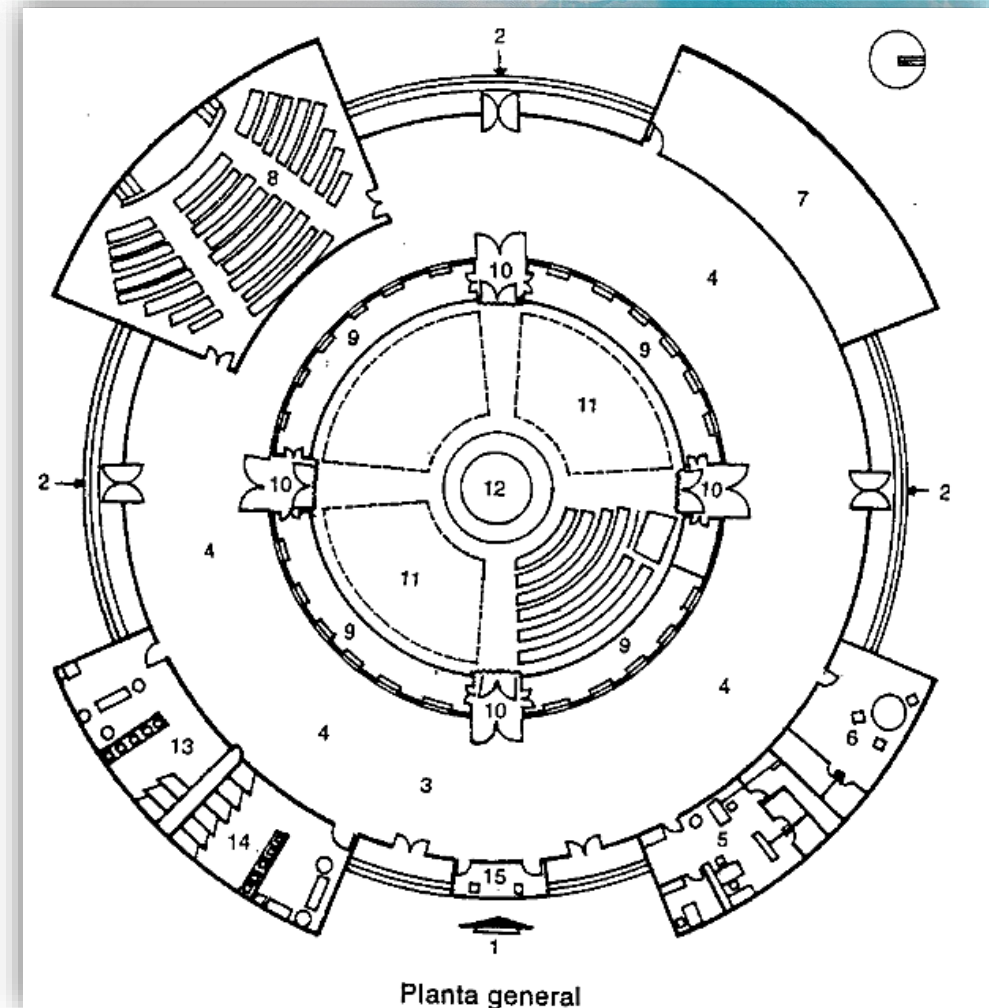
Planetario Licenciado Felipe Rivera. Planta arquitectónica
